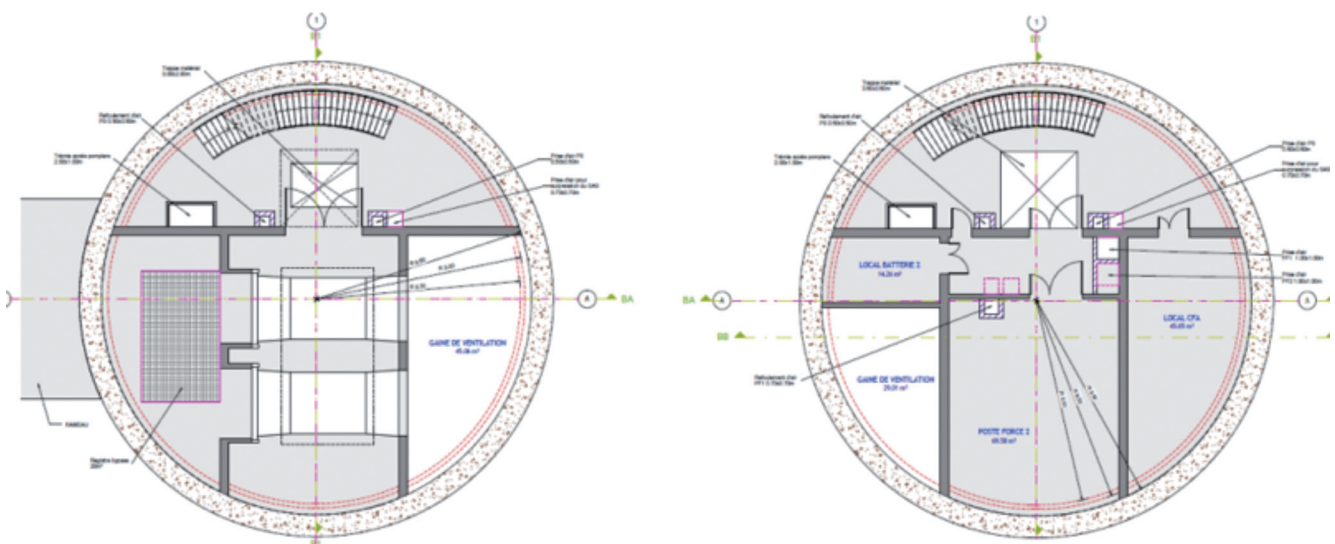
Vues en plan de plusieurs niveaux d'un puits type 5
